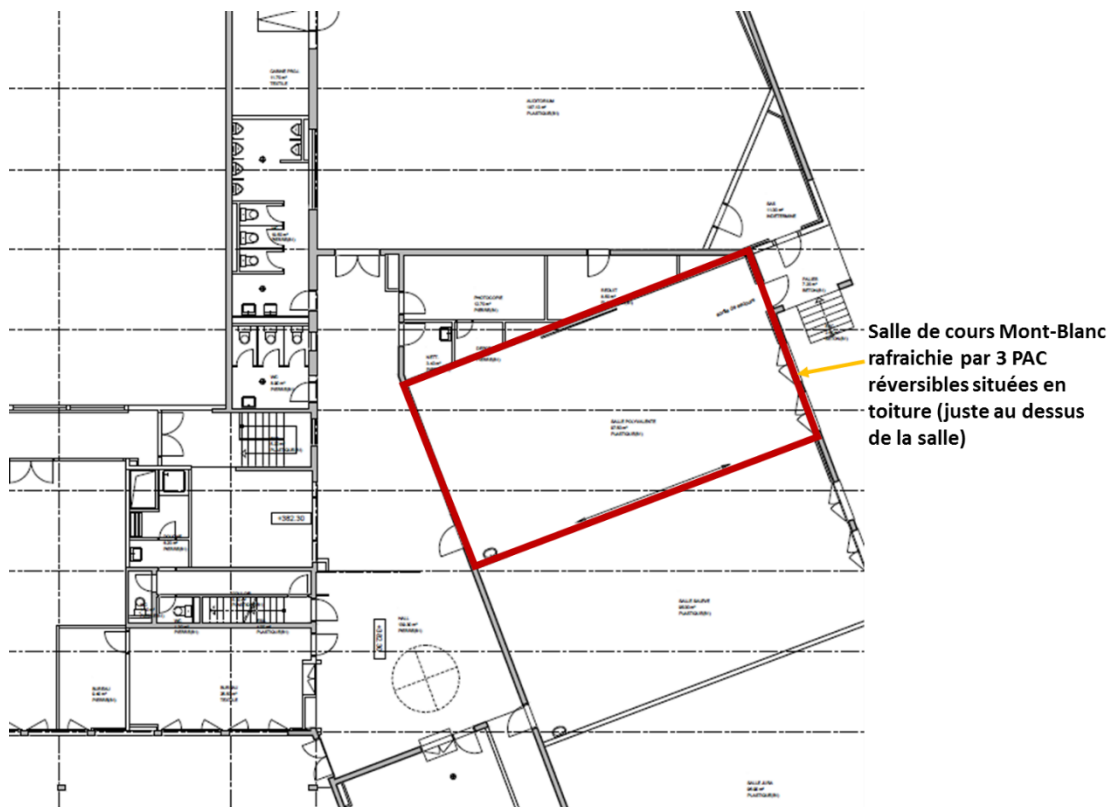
Localisation de la salle de cours Mont-Blanc sur le plan du rez-de-chaussée
